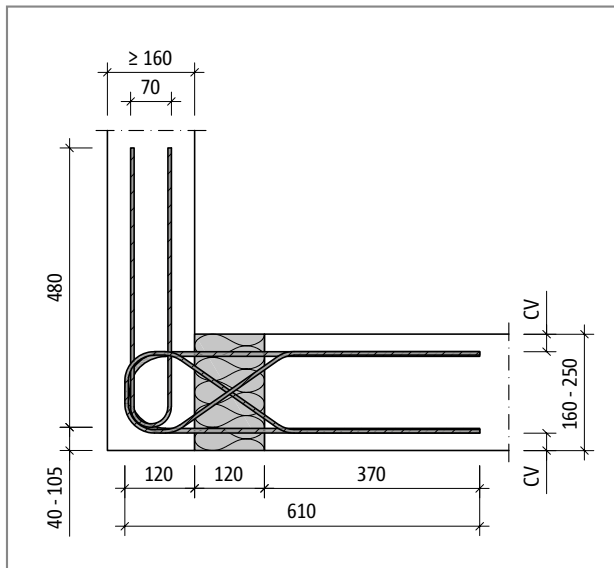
Schöck Isokorb® XT Typ F: Produktschnitt
